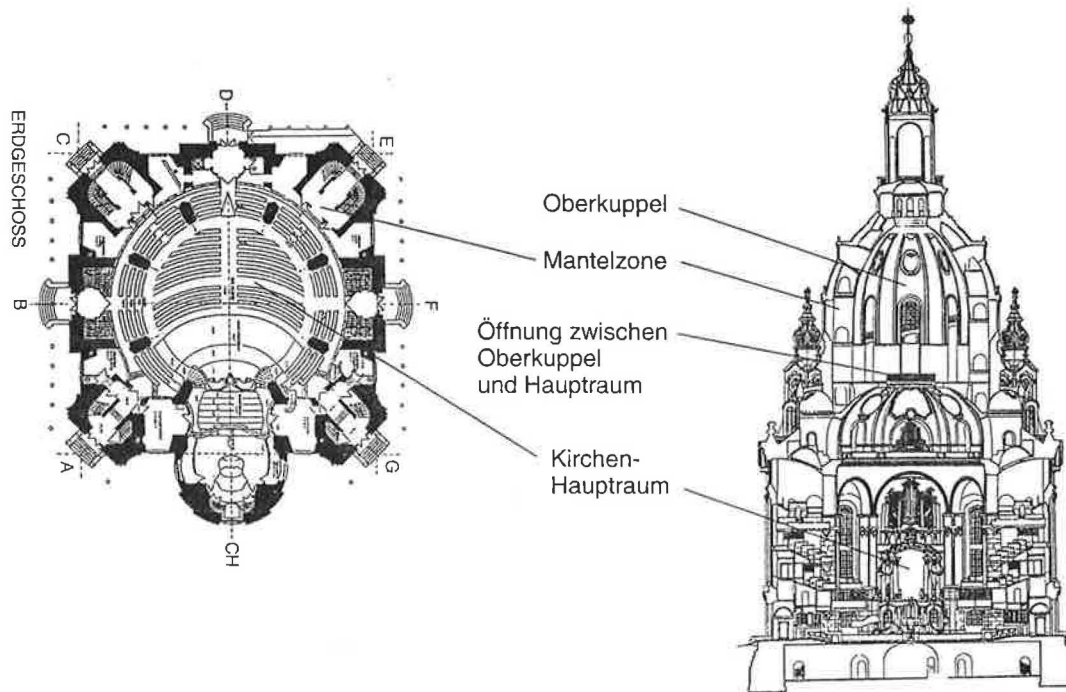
Frauenkirche in Dresden – Schnitt und Grundriß (nach Zeichnungen von Ipro Dresden).
